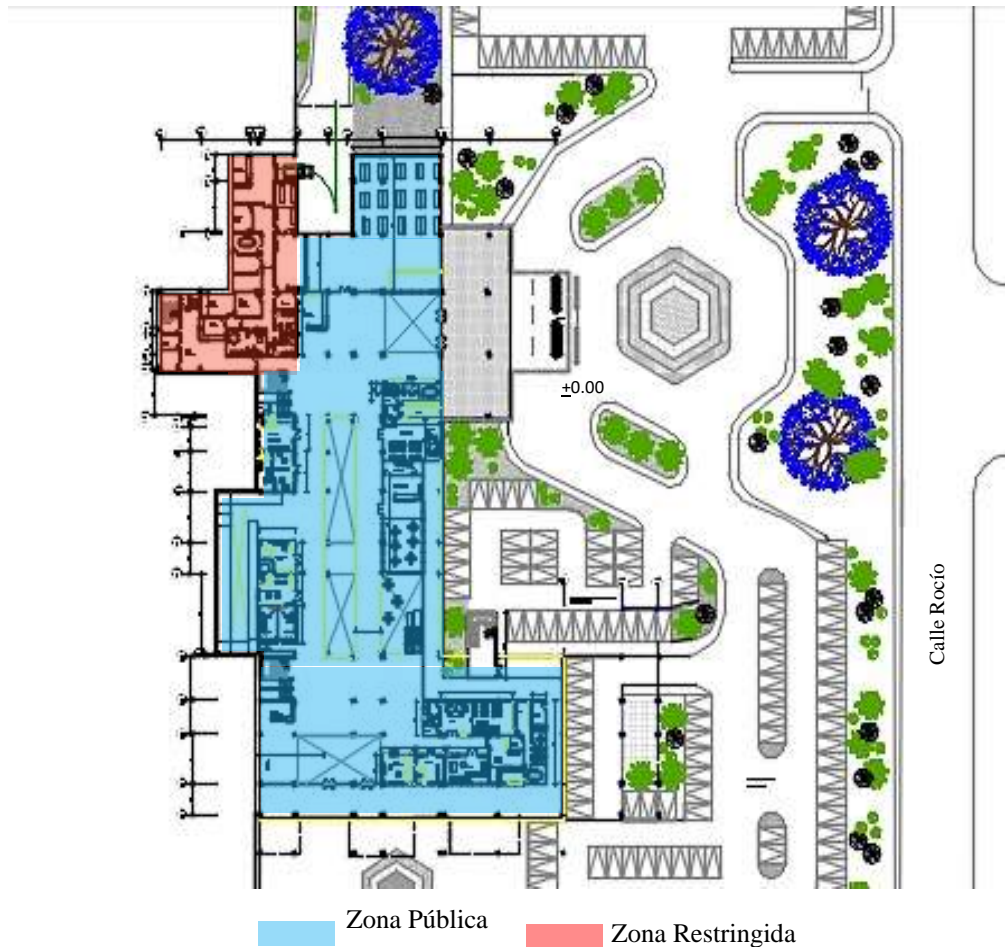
Zona pública, semi-restringida y restringida de planta baja (2017)
